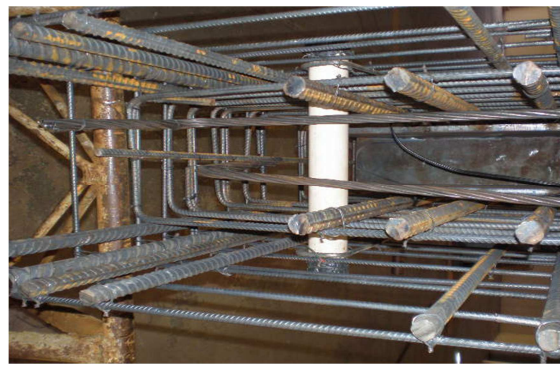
Montagem da fôrma e armação dos pilares pré-moldados.
